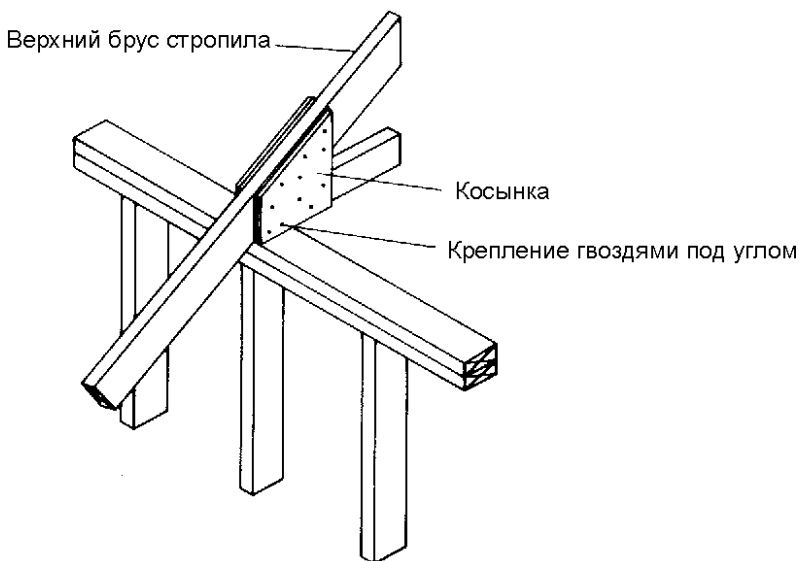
Крепление стропильной фермы к брусу верхней обвязки стены через косынку гвоздями под углом
